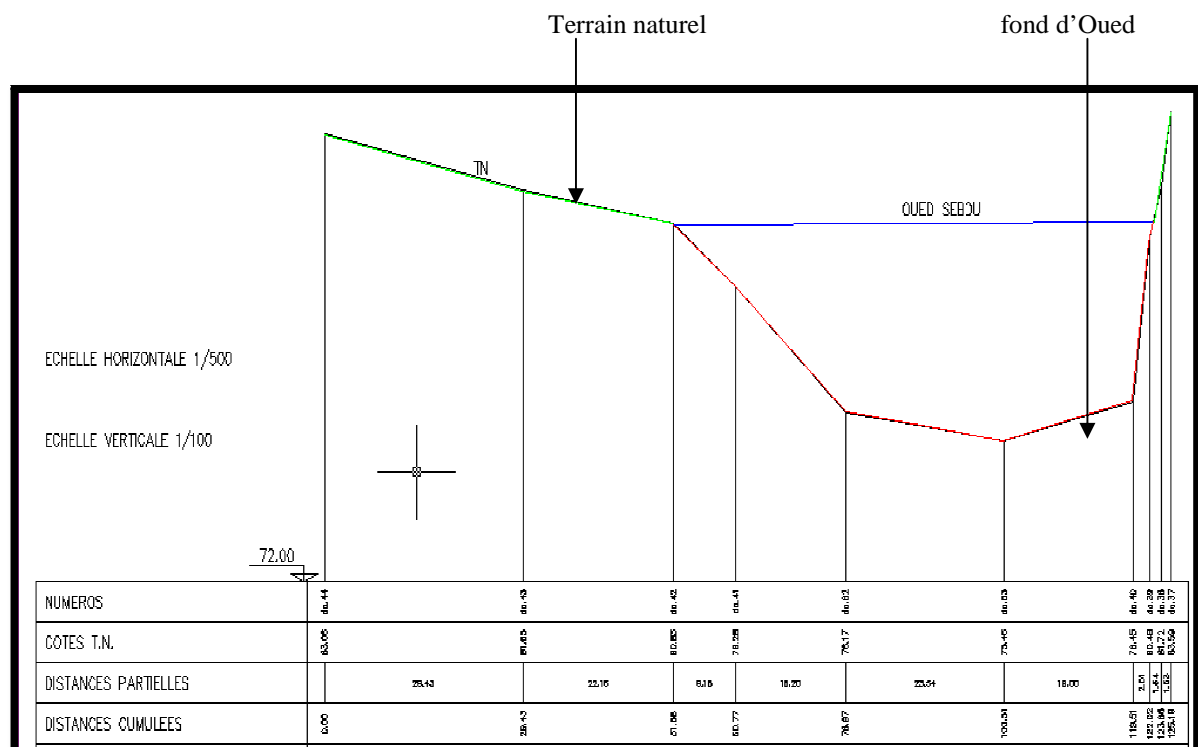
Le profil en travers de la coupe 3 d'Oued Sebou
